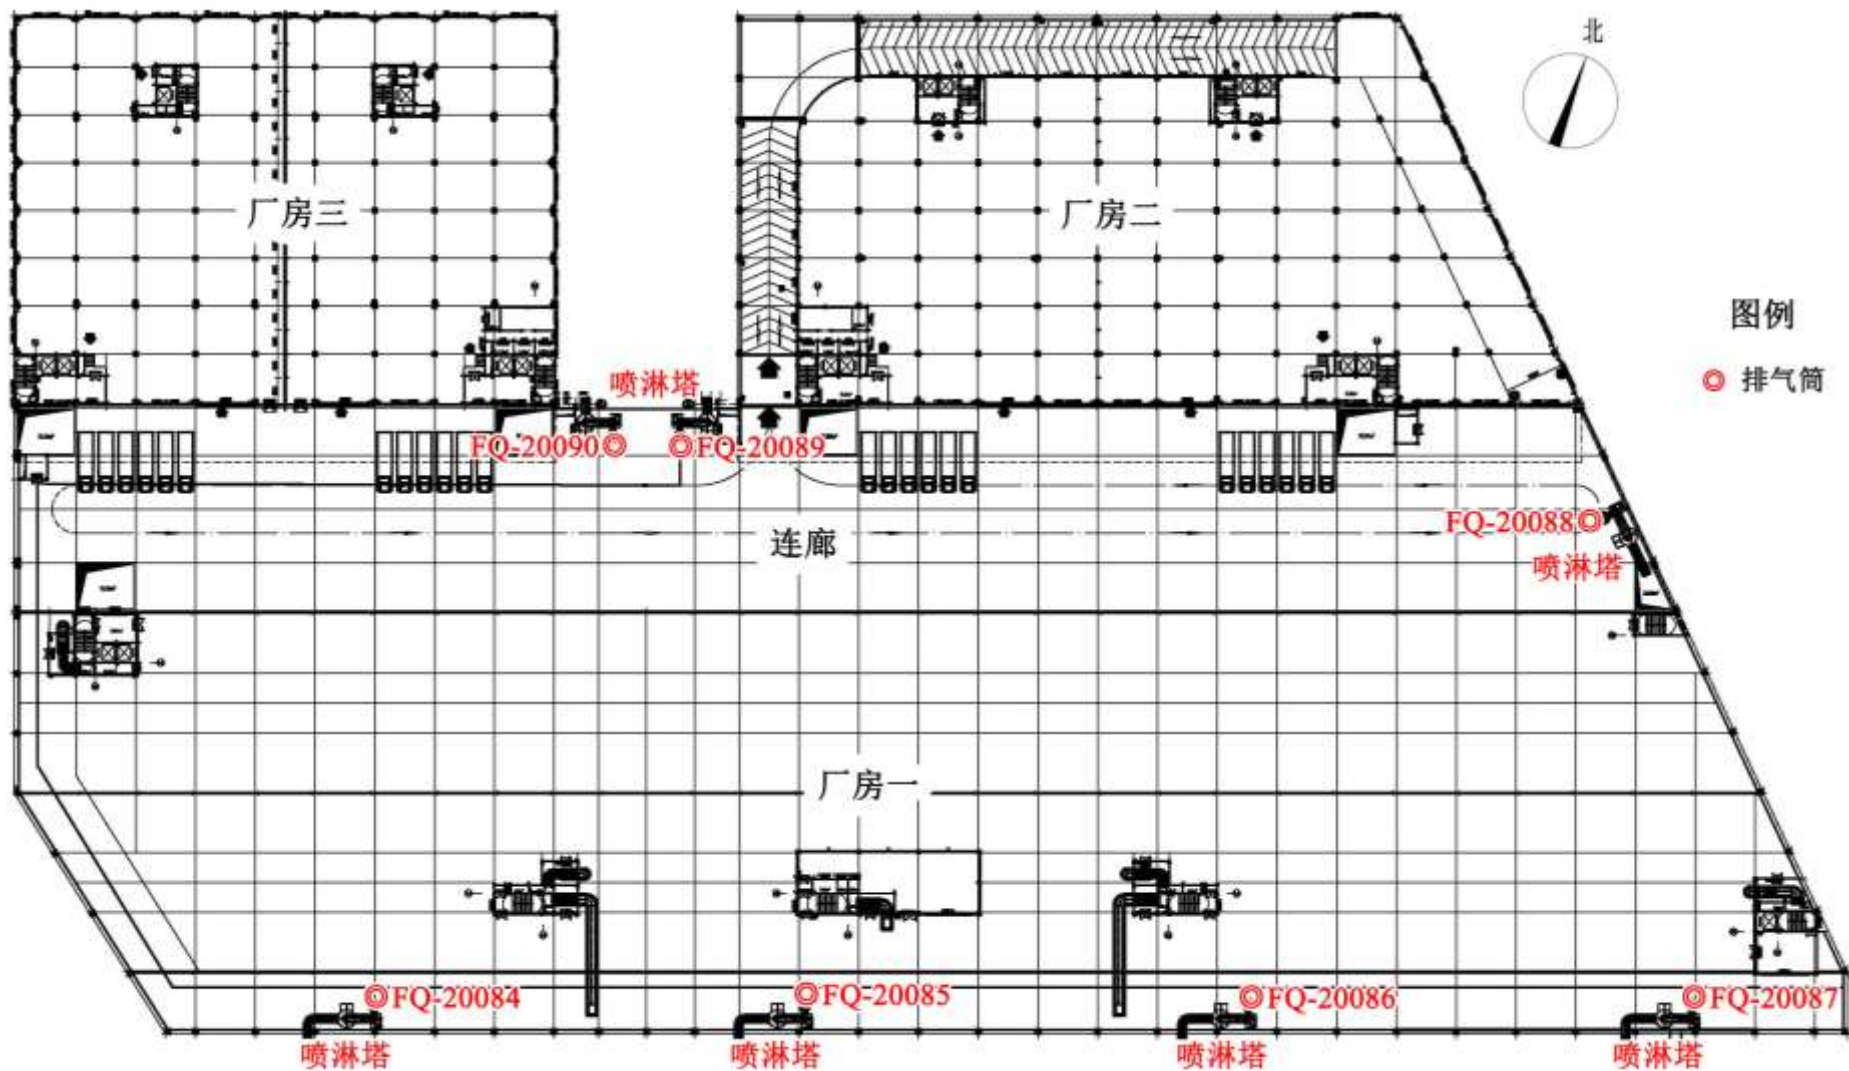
厂房一和连廊楼顶废气处理设施平面图
